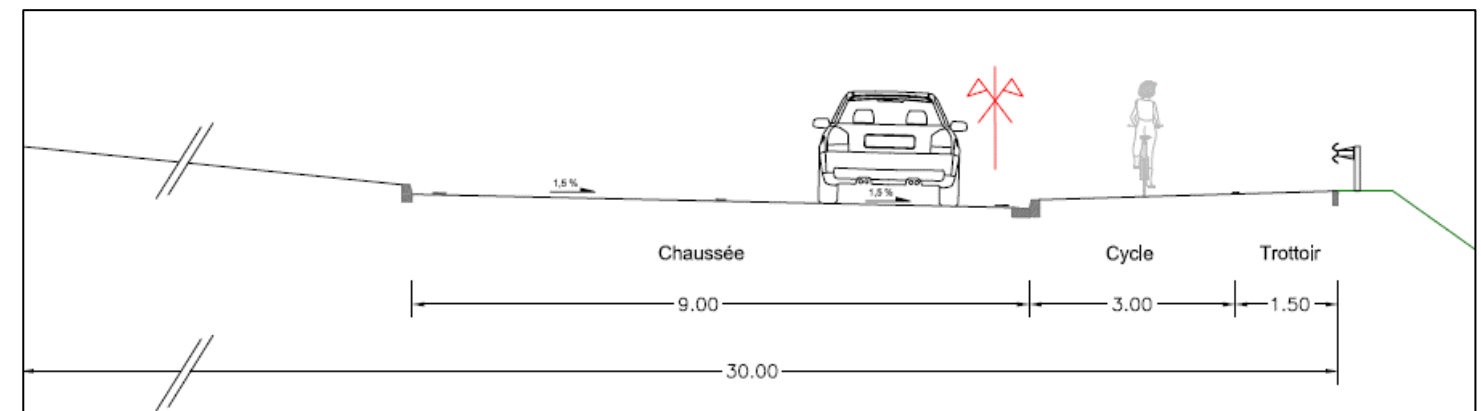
profils en travers type au niveau du futur giratoire sur l'avenue Pierre Mendès France (source : Profils en travers types - AVP 04/2018 / 1/75ème)
